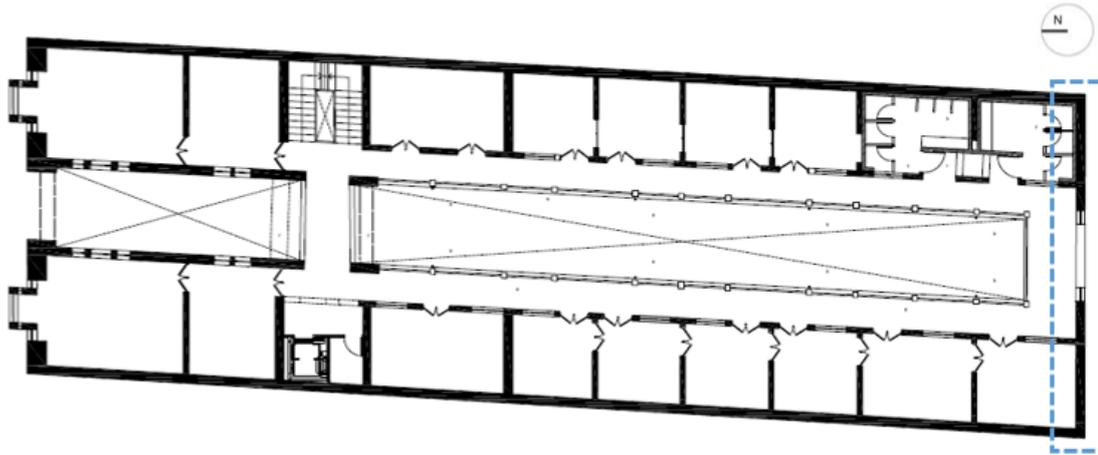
Plano del Pasaje León, planta alta, en donde se señala el muro intervenido.
